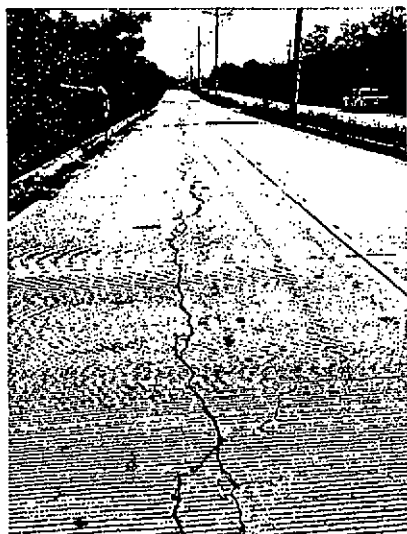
Grietas longitudinales en el Pavimento
